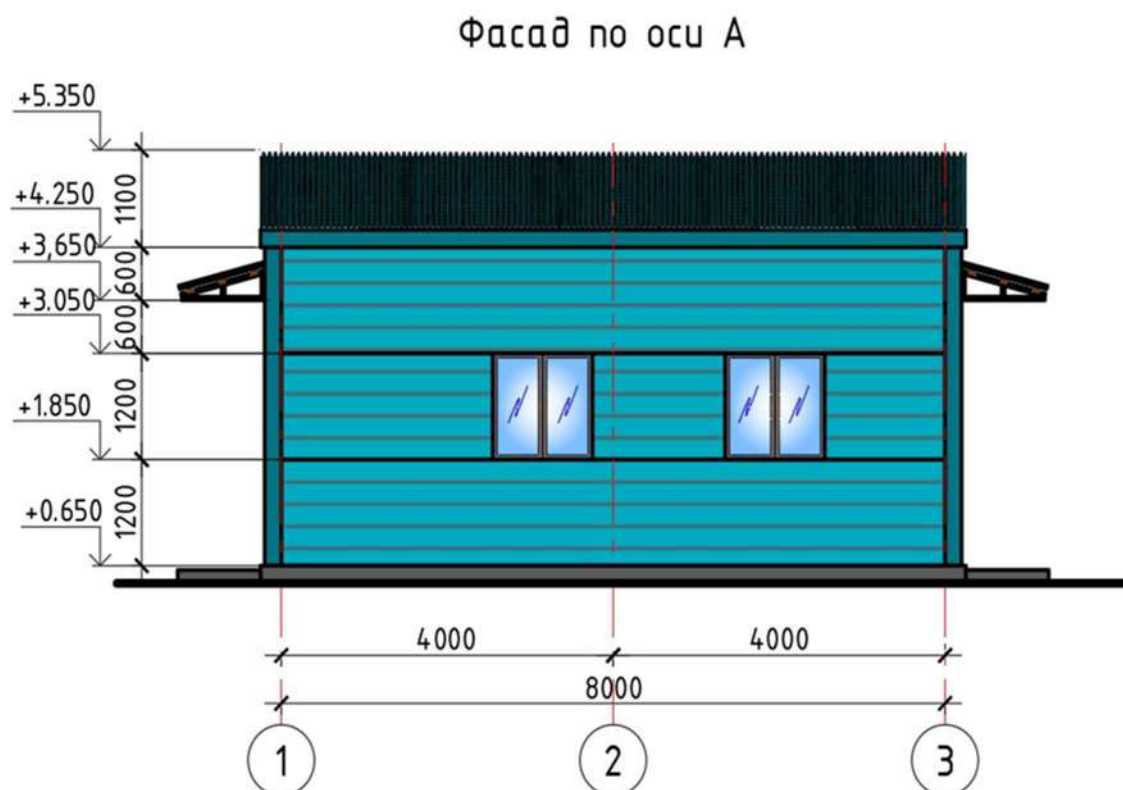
Фасады здания насосной станции пруд накопителя оборотной кислой воды
